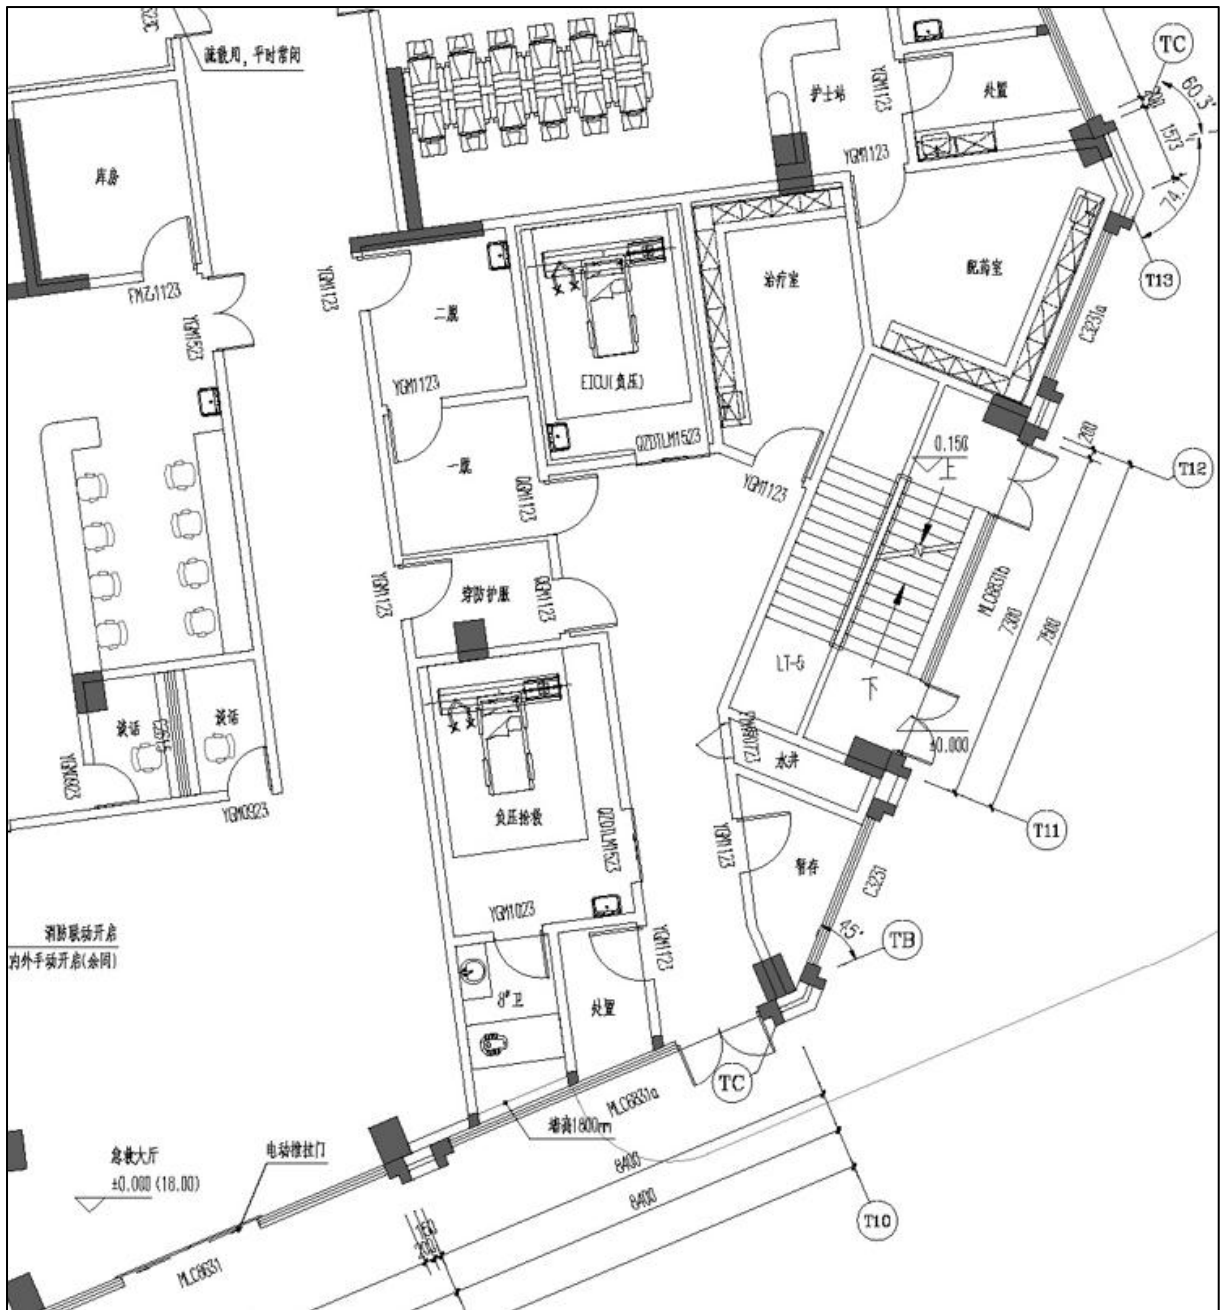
(22) 一层负压抢救、负压 EICU 平面布置
